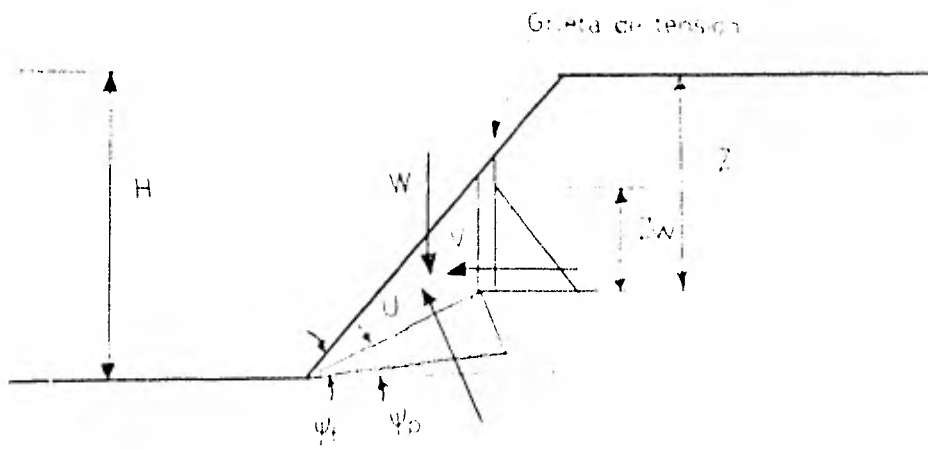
Grieta de tensión en la parte inferior del fuste.
